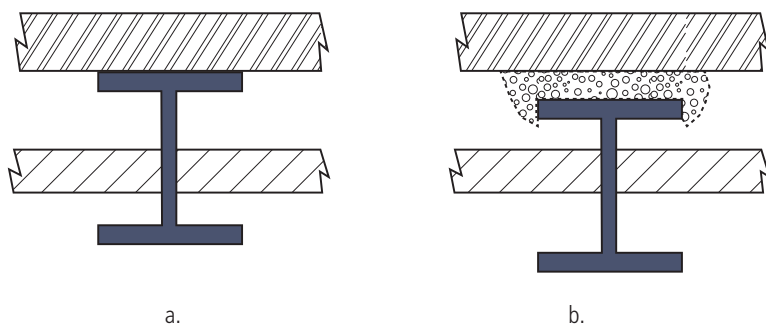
Structure en acier exposée à l'eau provenant de l'extérieur (coupe horizontale)
